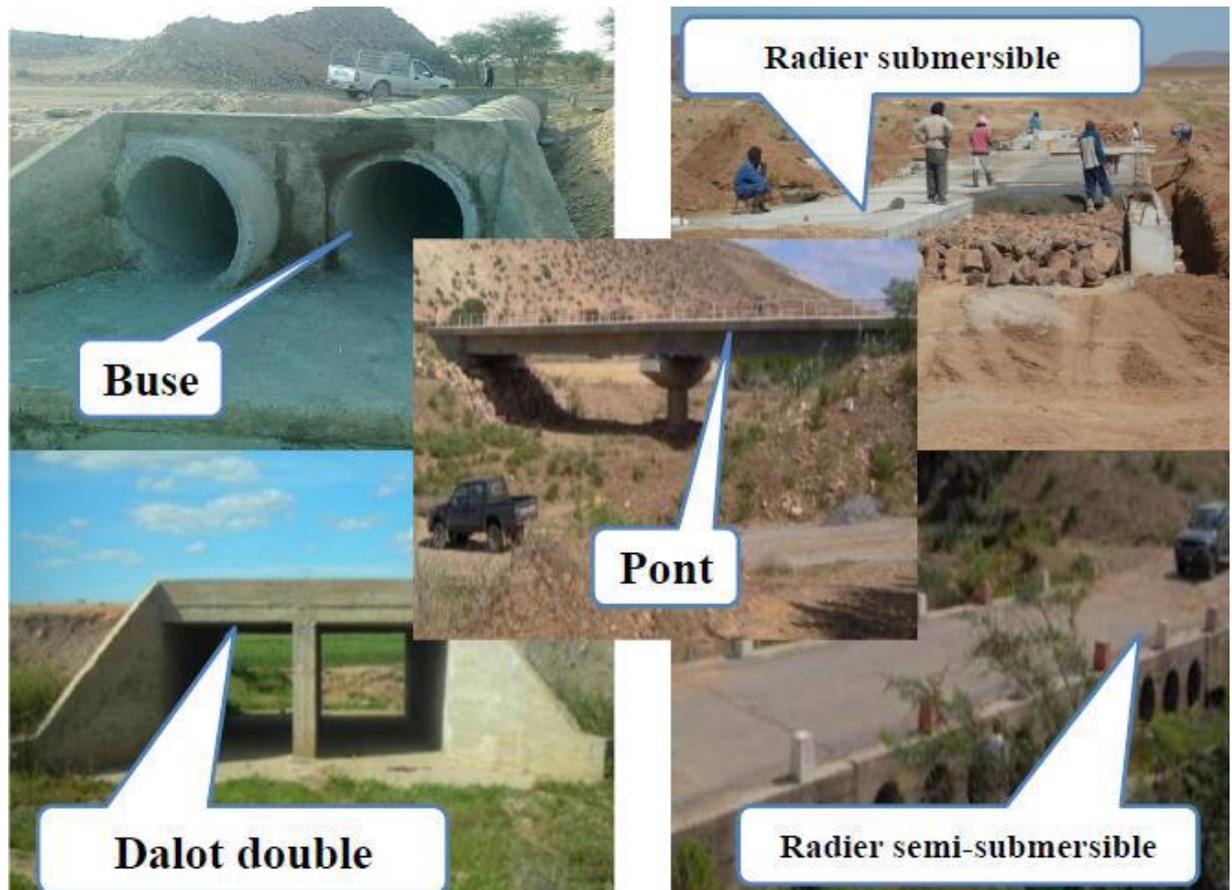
Exemple d'un ouvrage de franchissement.
